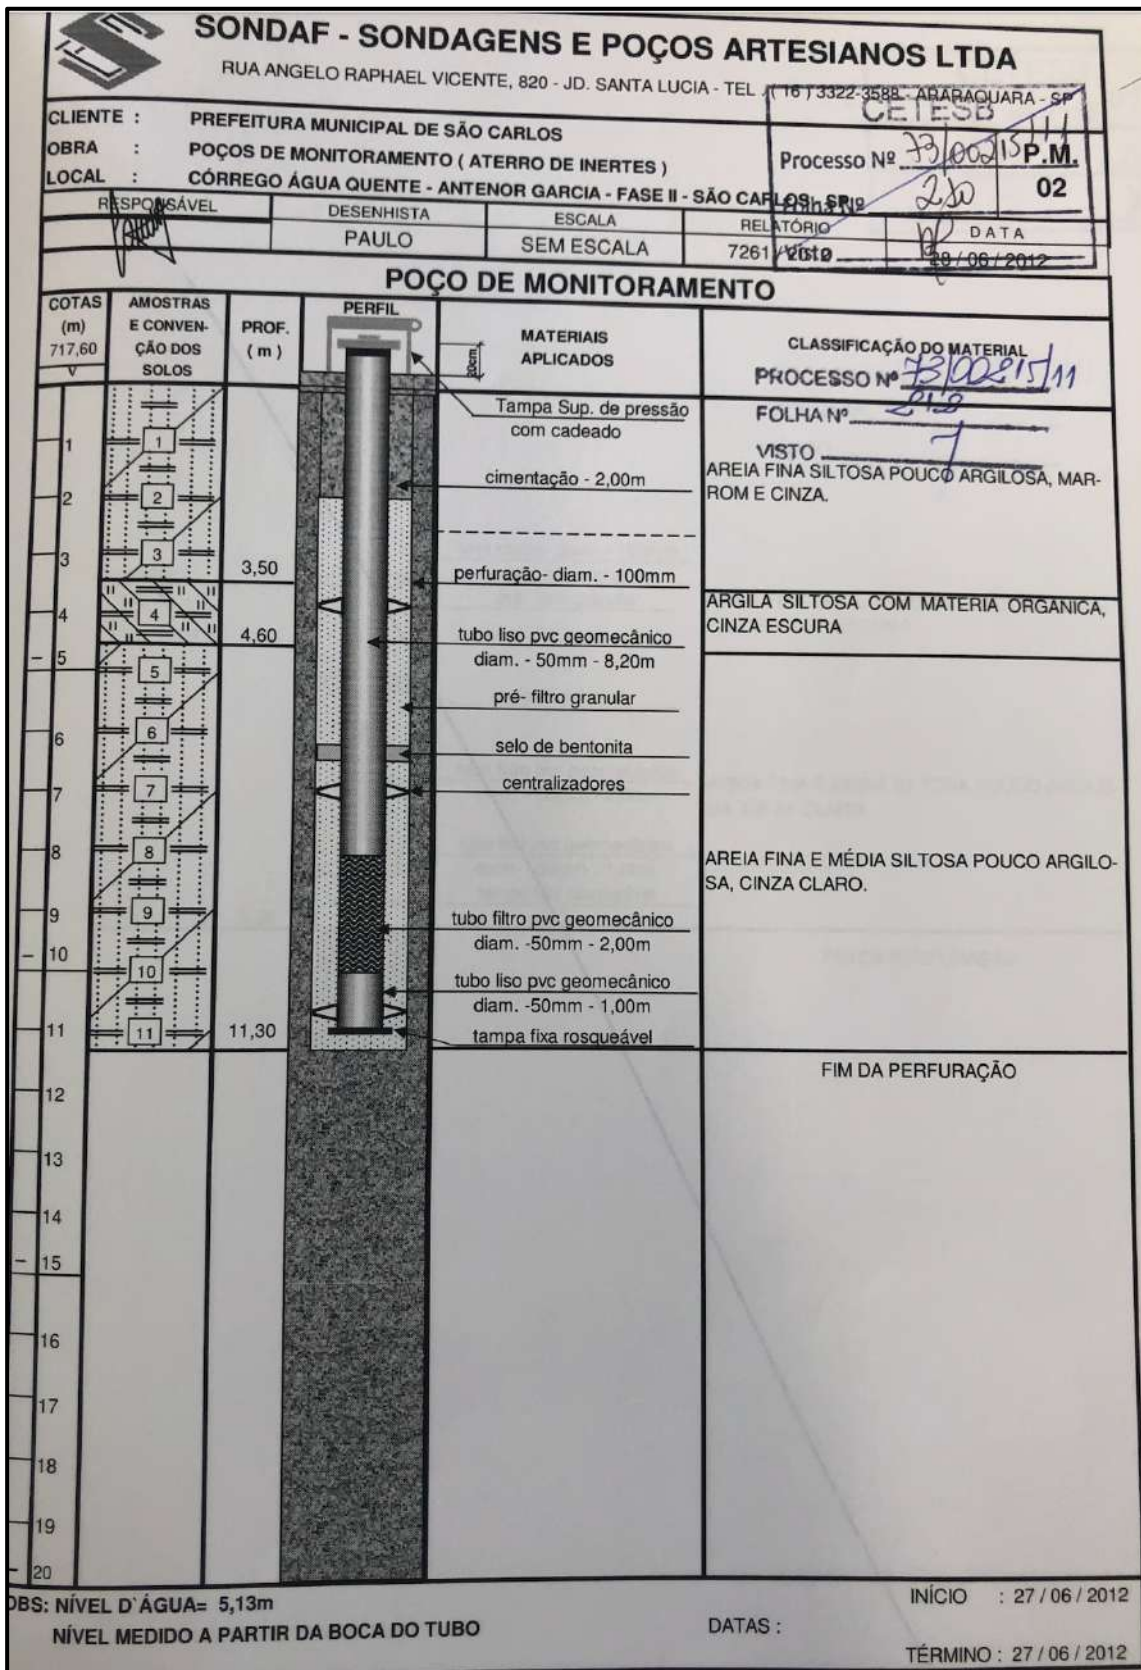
Figura LIV: Perfil construtivo do poço de monitorização PM-02
